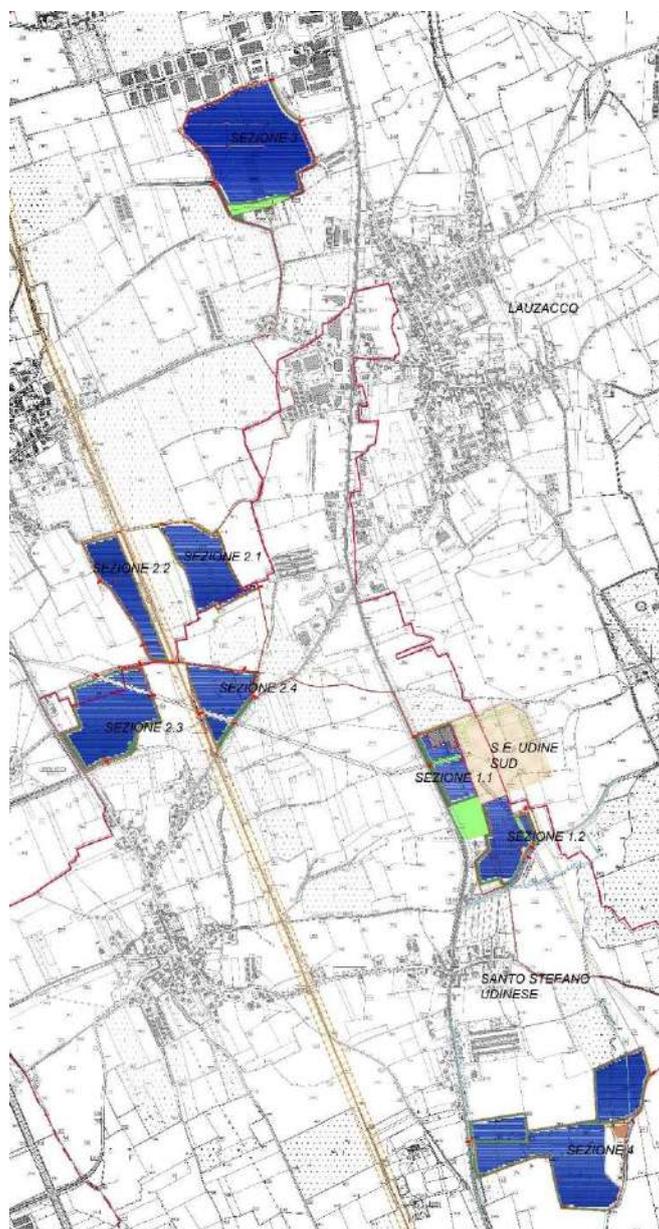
Estratto planimetria generale con individuazione dell'intervento
